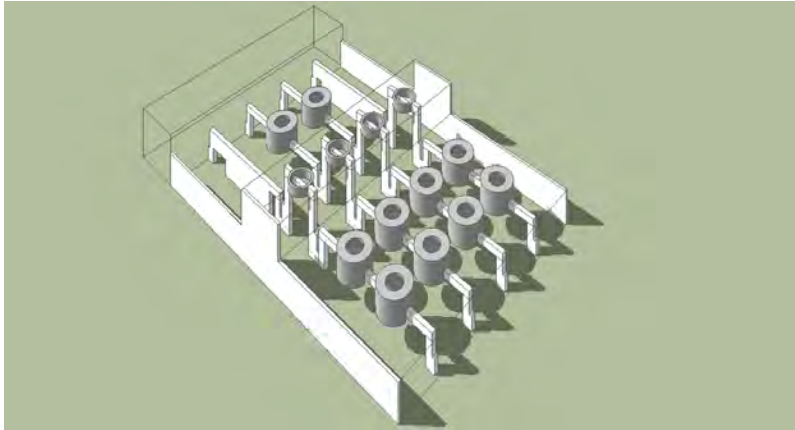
Las dos vigas de arriostrado de los seis planos constructivos principales.
